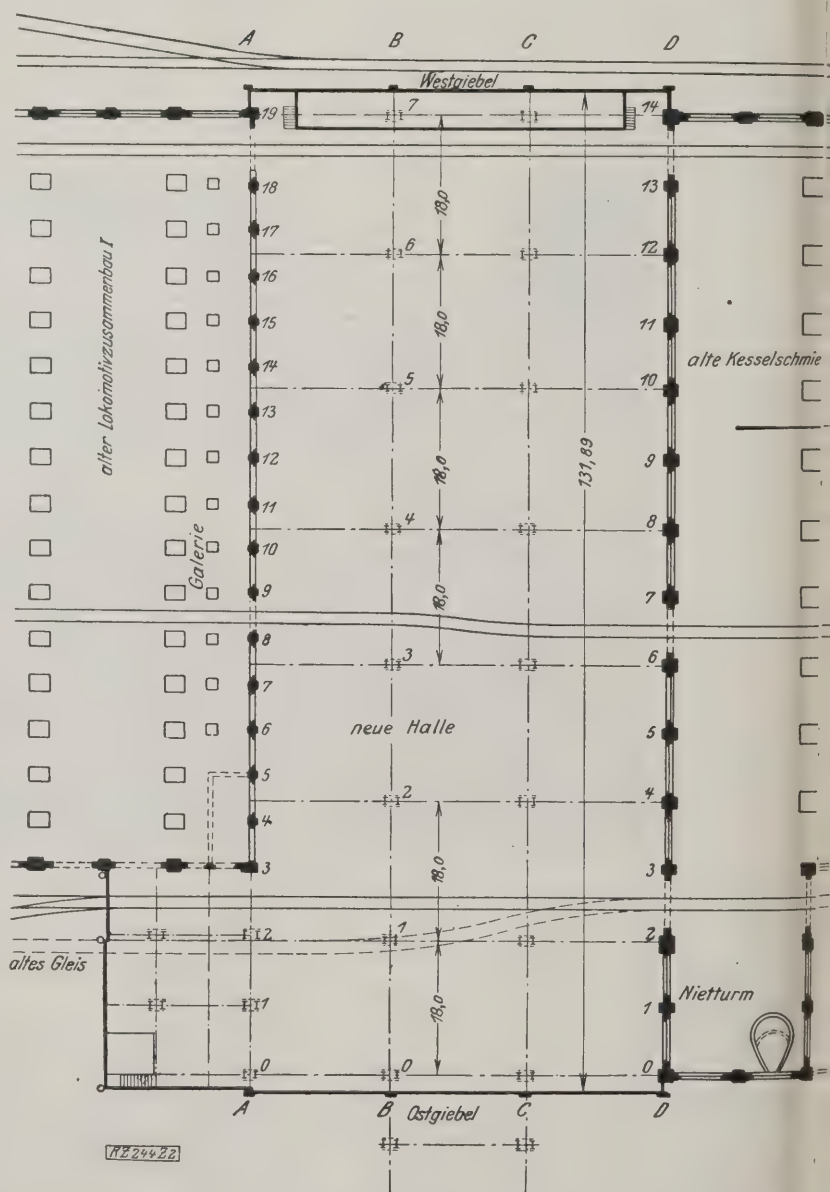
Grundriß der neuen Halle mit ihren Stützenstellungen.
